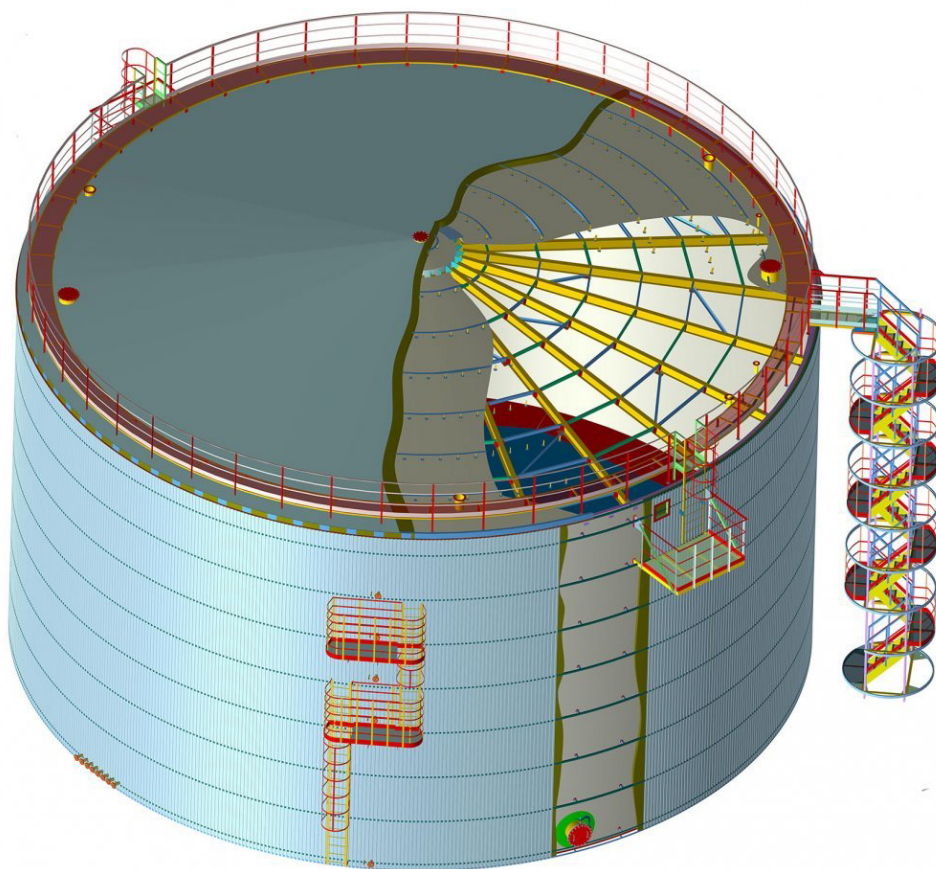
Вертикальный стальной резервуар типа РВС 24
